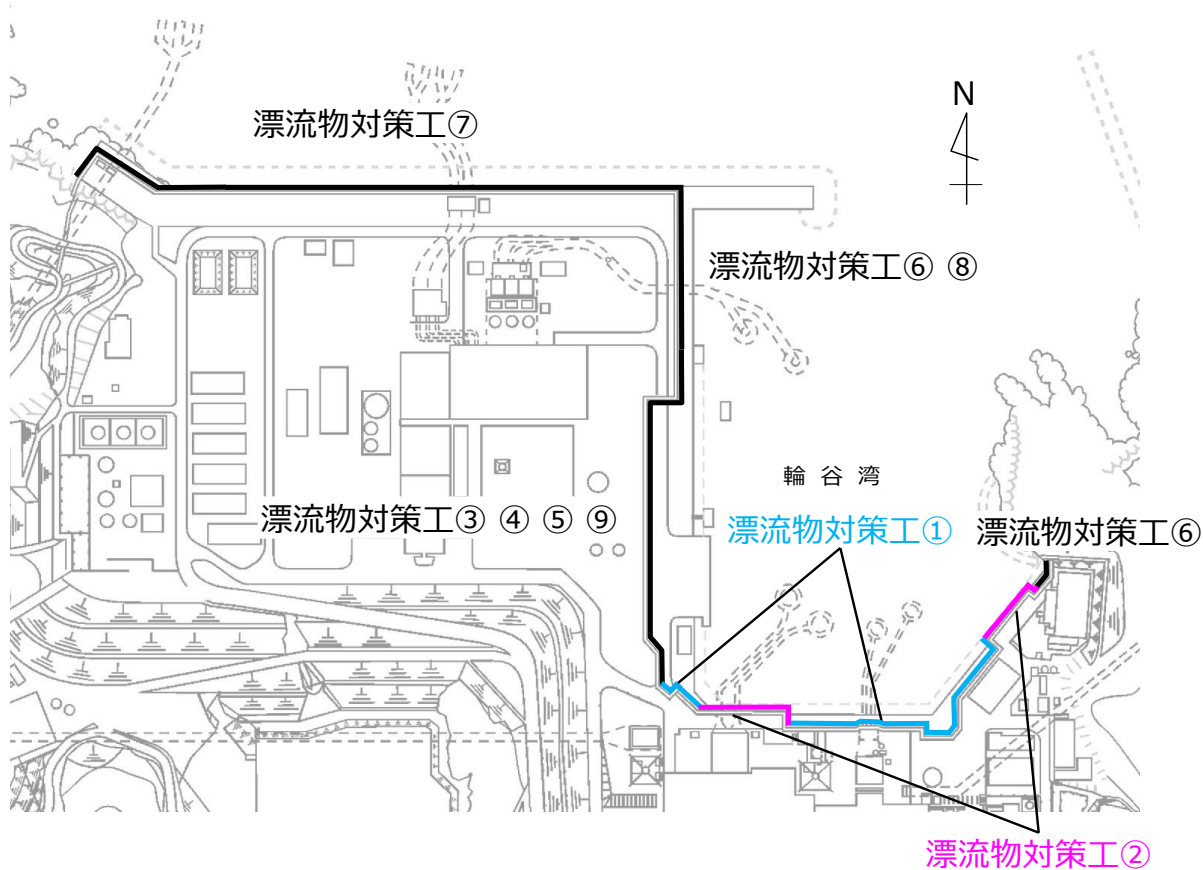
漂流物対策工（鉄筋コンクリート版）の構造区分図
